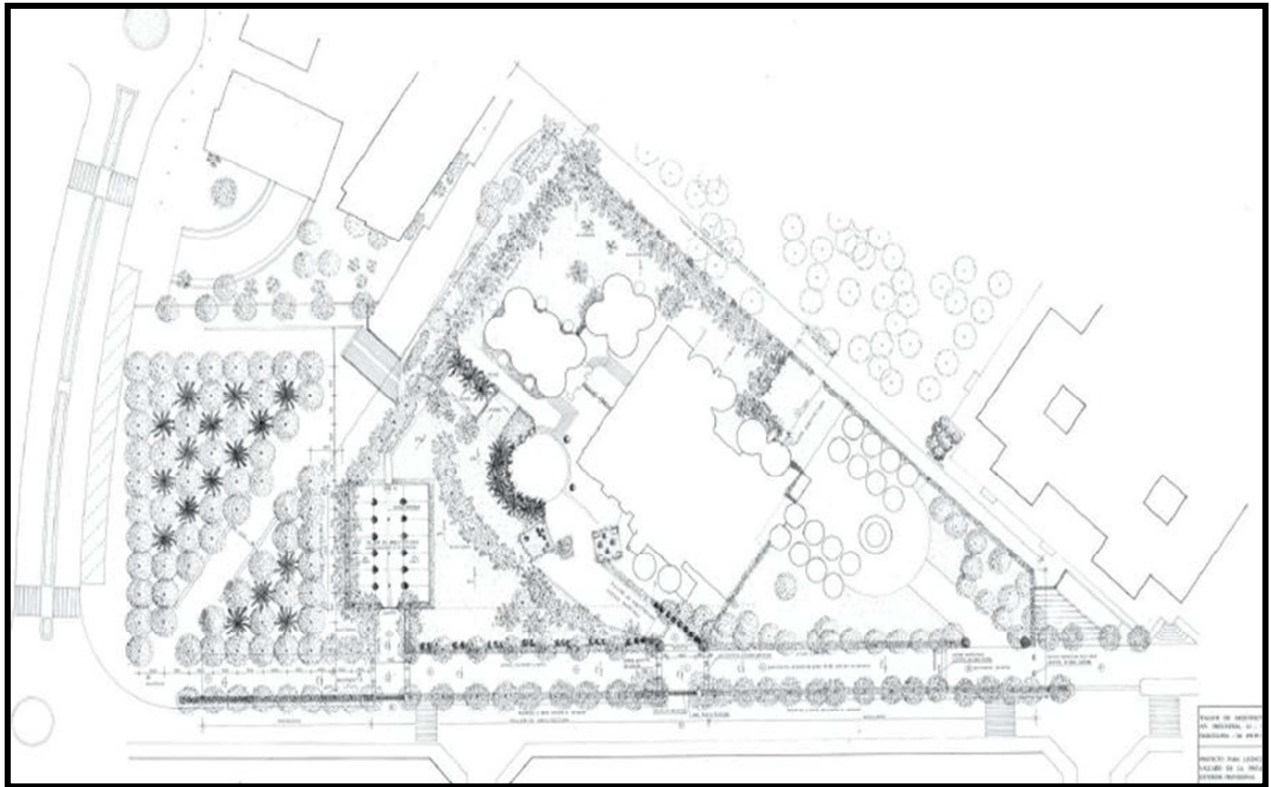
plan de masse de la cimenterie de Ricardo bofill, source : : Taller de Arquitectura ou la fabrica - Ricardobofill
